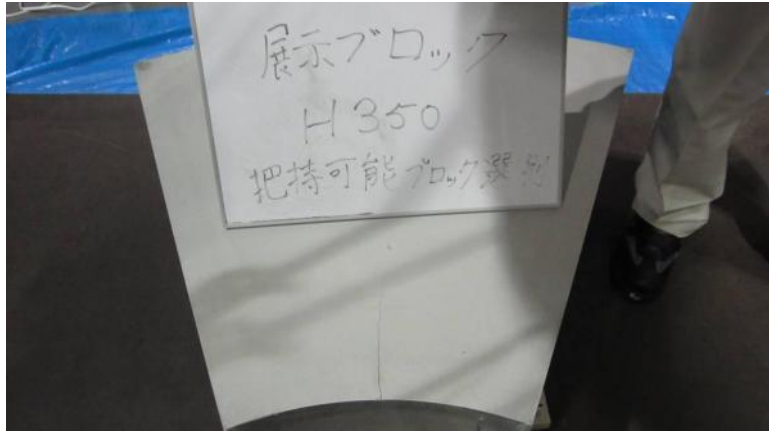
緩衝材（展示用）のひび割れ（例）
